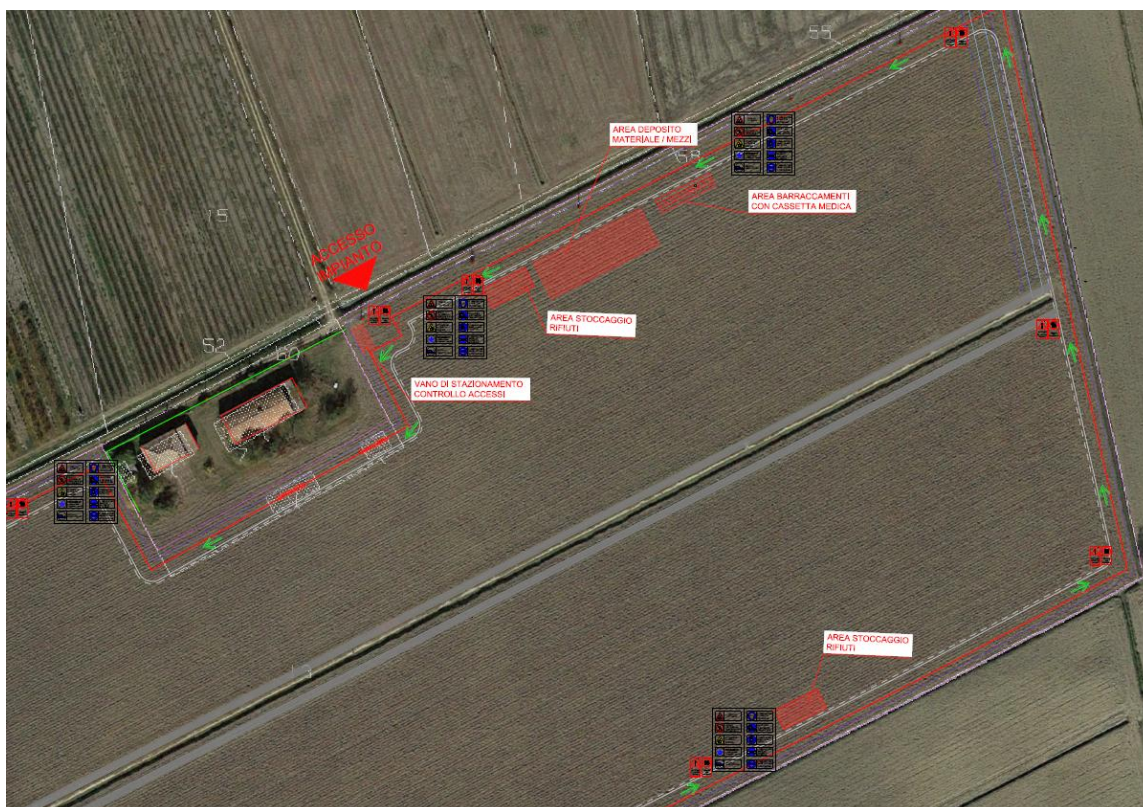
Organizzazione delle aree di cantiere – Dettaglio impianto a nord-est
